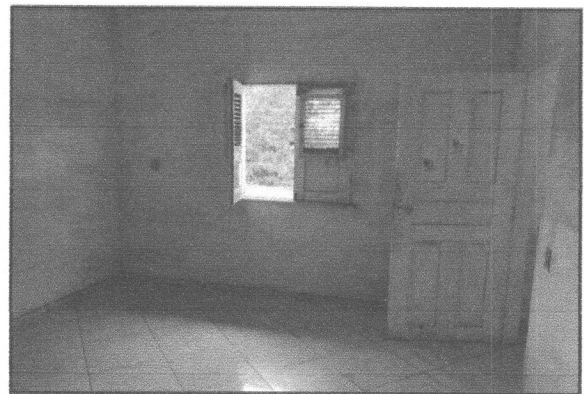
Quarto do pavimento superior, com revestimento cerâmico no piso, porta e janela com esquadrias de madeira.
